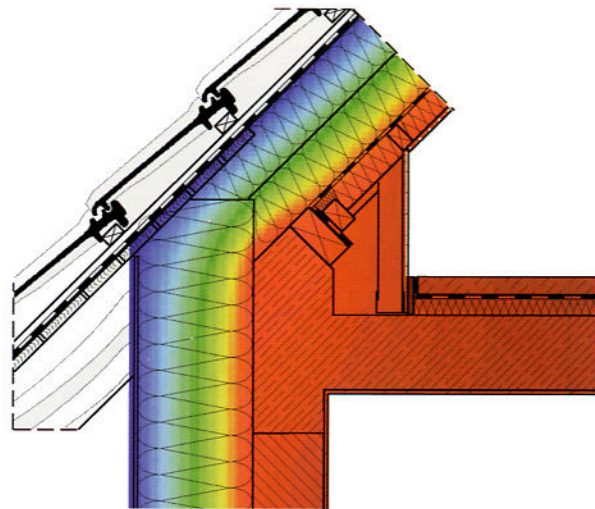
Flux thermique : coupe d'un avant-toit et d'un débord du toit (toit élevé)
